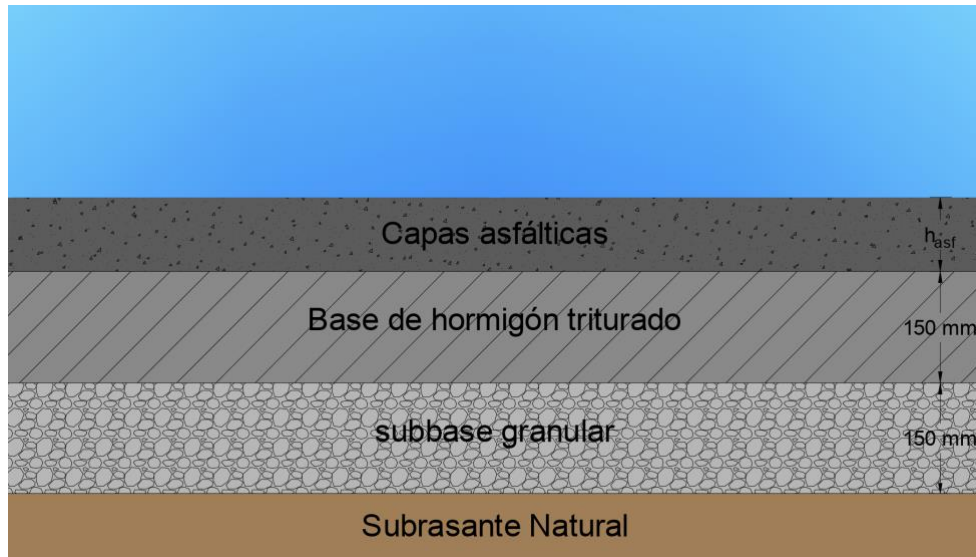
Esquema de estructuración prevista para rehabilitación de pavimento.
